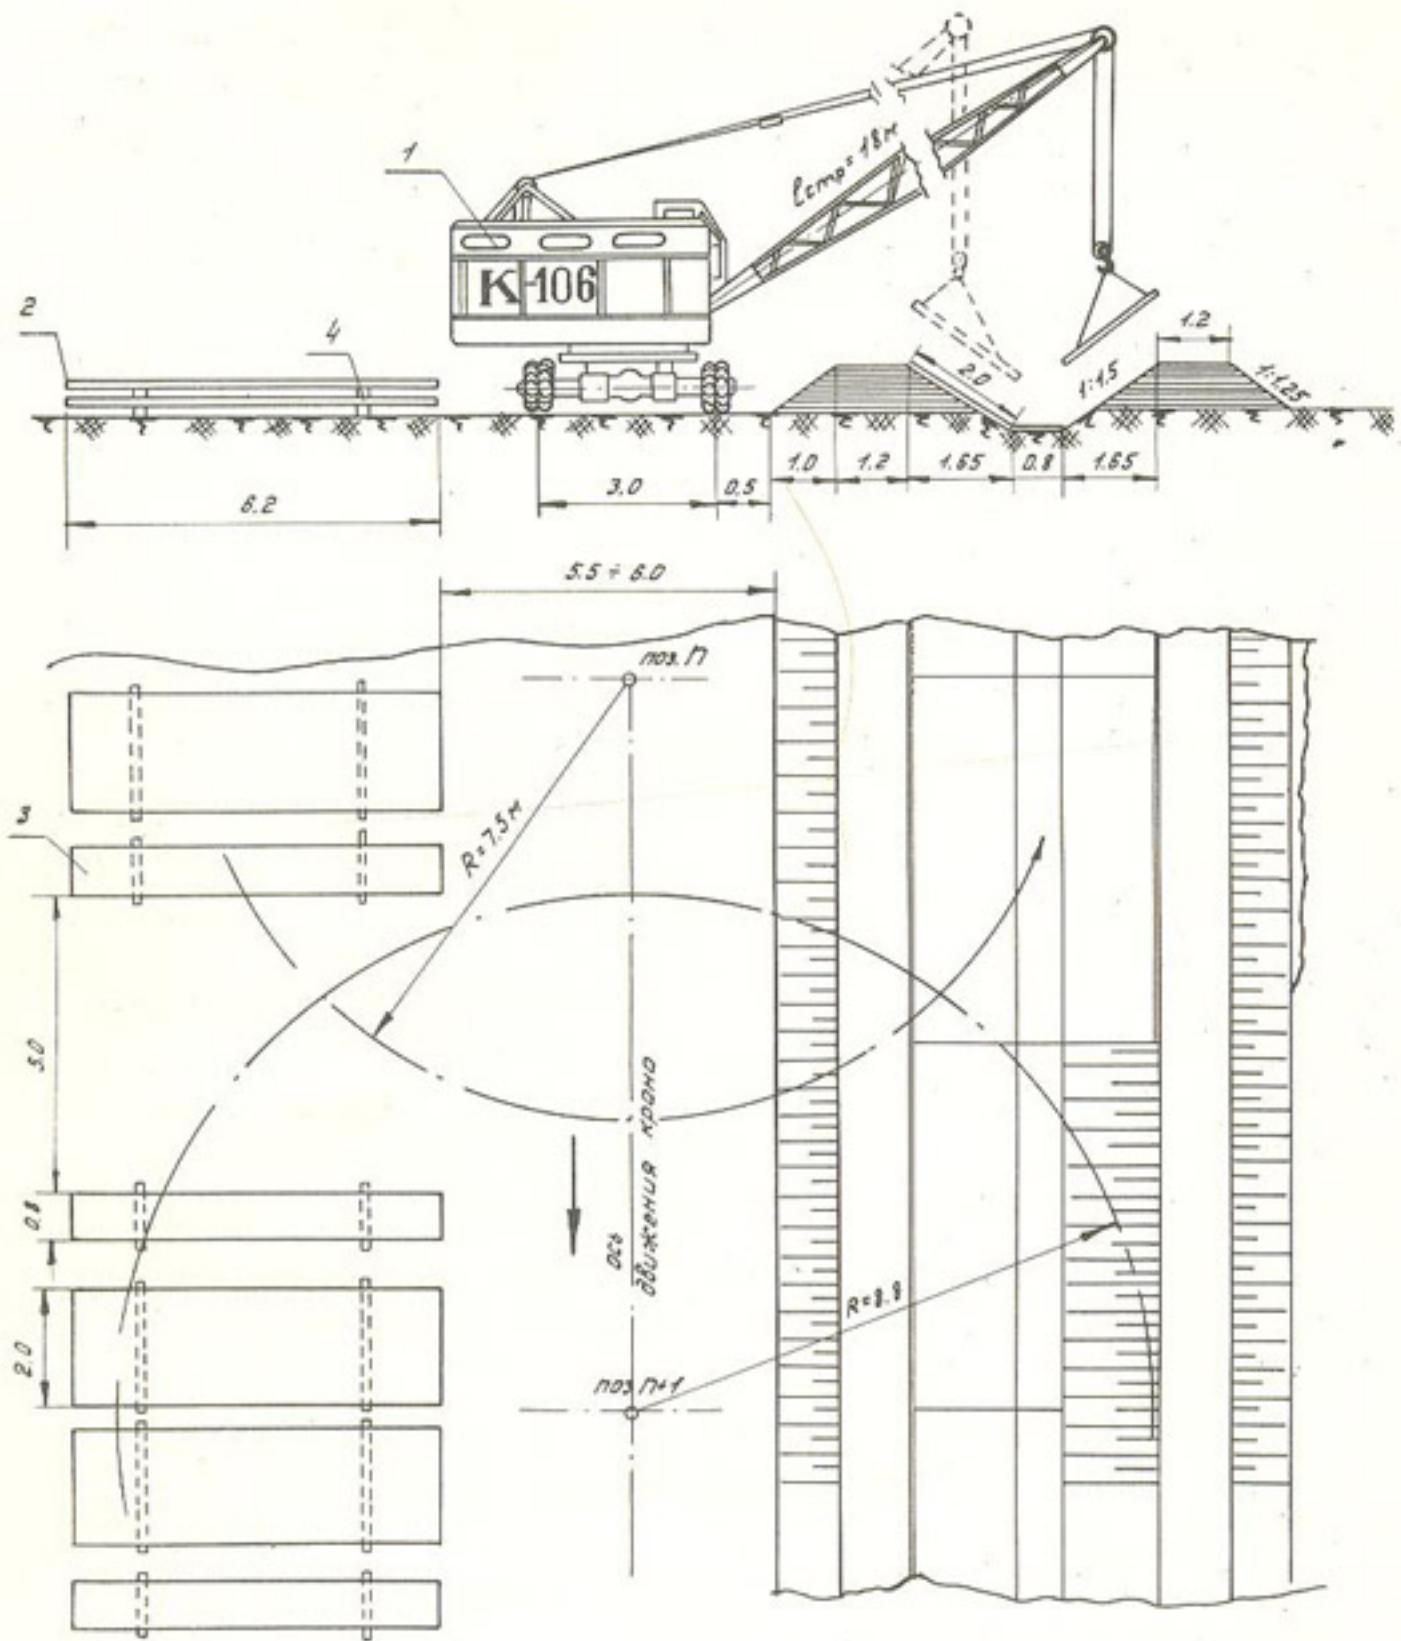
Схема монтажа сборной облицовки из железобетонных плит пневмоколесным краном К-106: 1-пневмоколесный кран г/п 10 т; 2-железобетонная плита размером 6,2x2,0x0,06; 3-железобетонная плита донная размером 6,2x0,8x0,06 м; 4-деревянная прокладка сечением 40x40 мм
